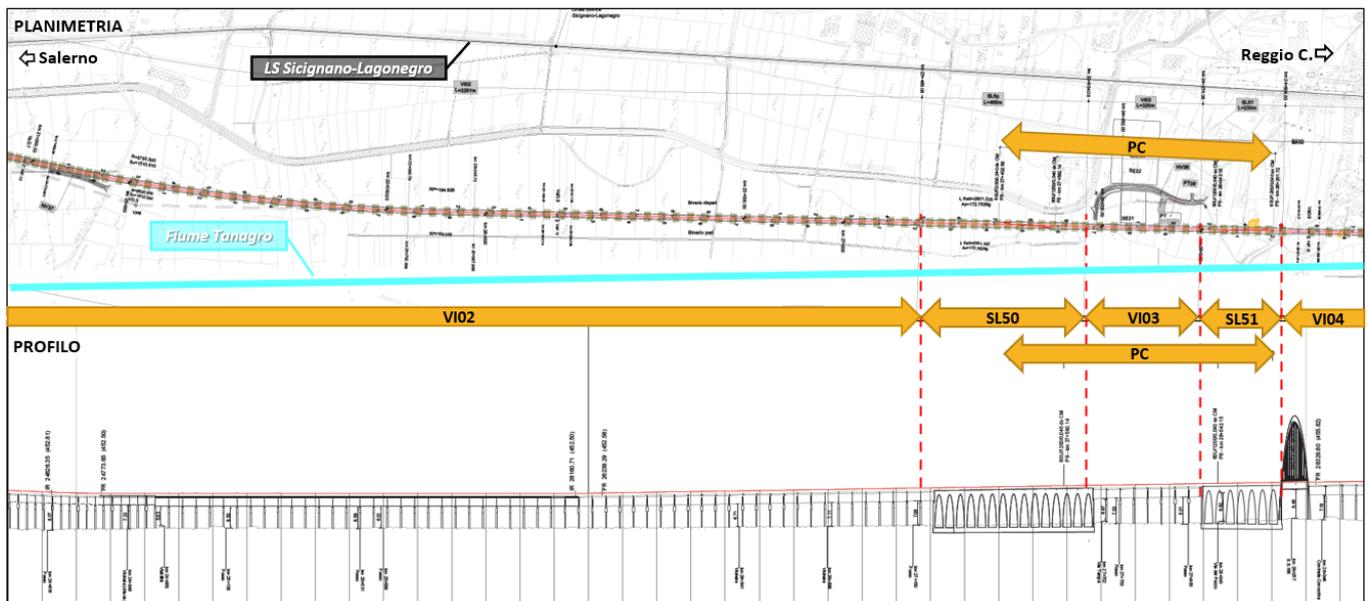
Planopprofilo di progetto da km 23+775 a km 28+266
